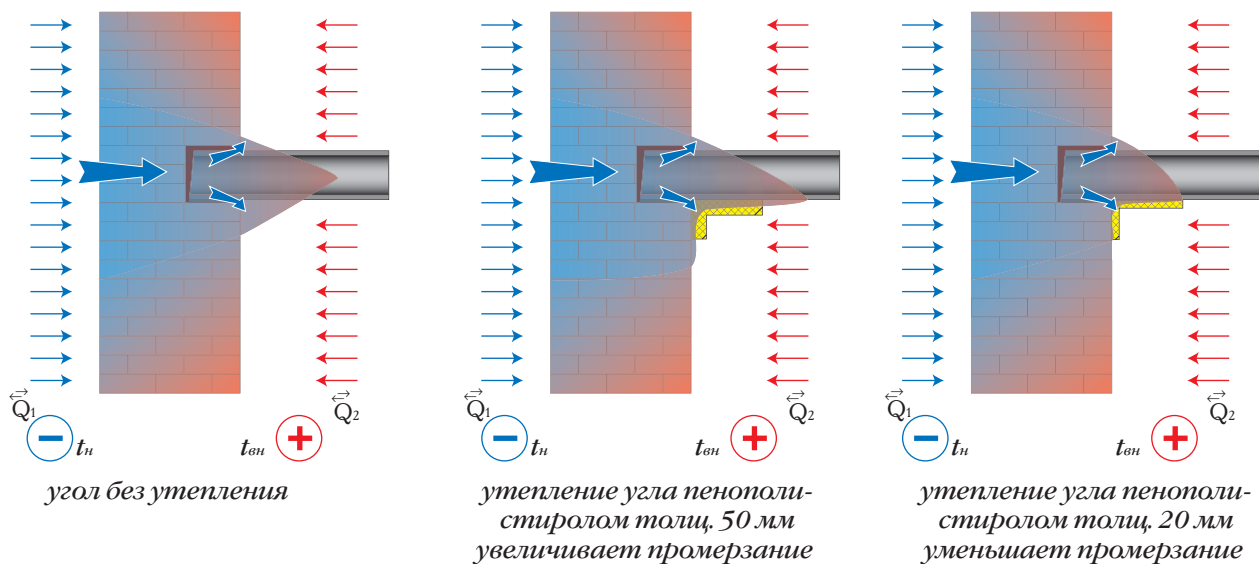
Промерзание стены в результате намокания стен под балконной плитой
